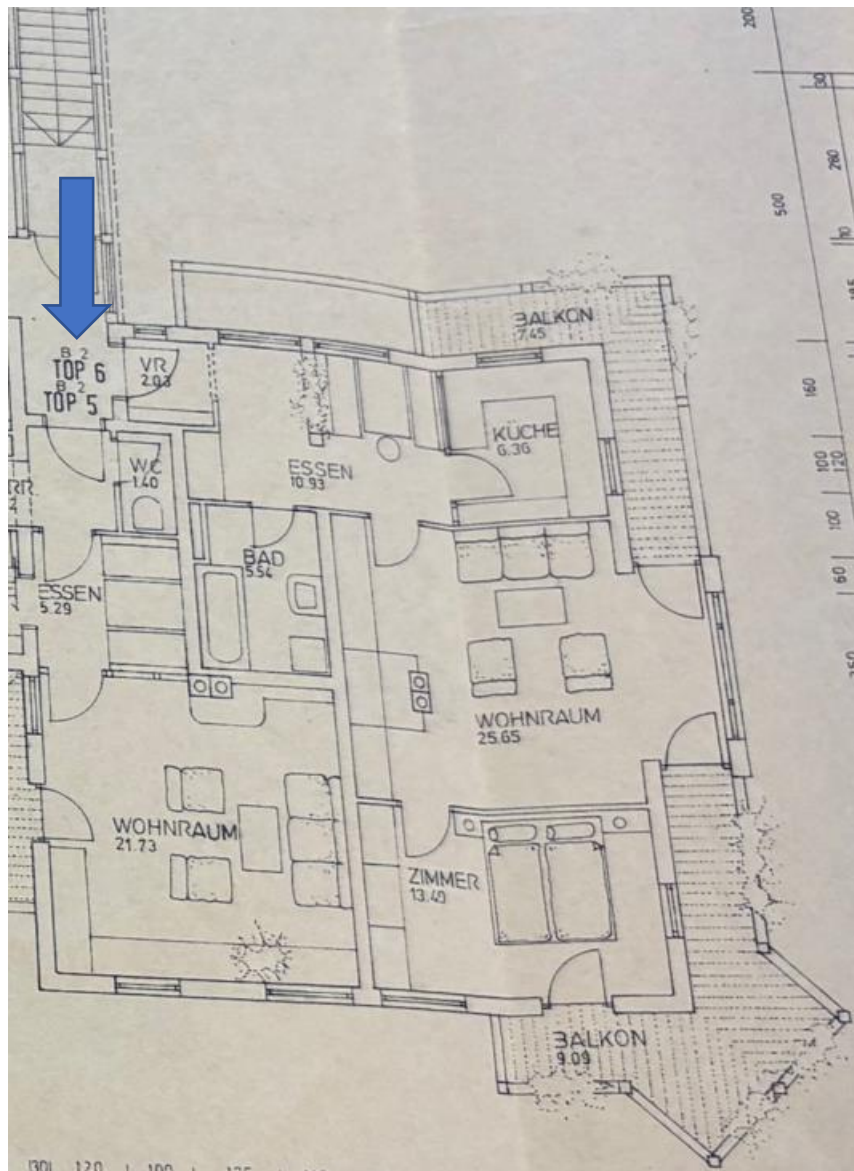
Grundriss Wohnung Top 6 gem. Einreichplan ZI 3165/85 v. 26.3.1986¹³
